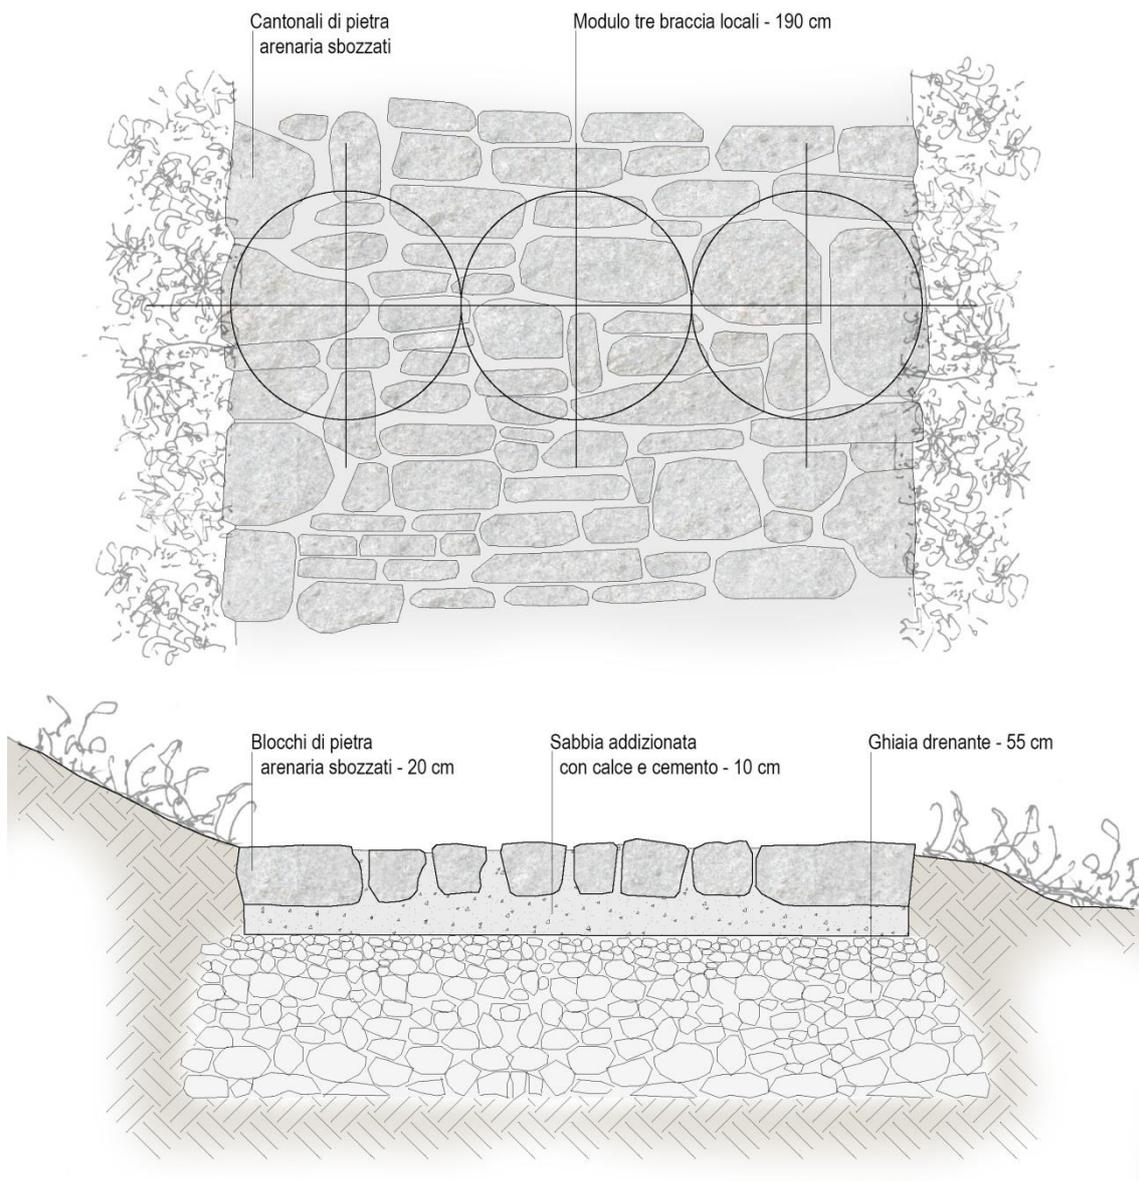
Dettaglio pavimentazione mulattiera, scala 1:20.
